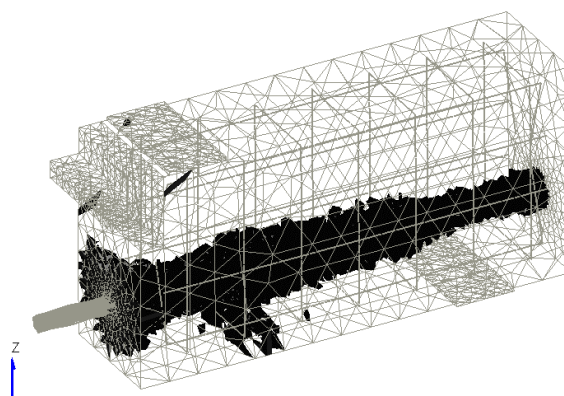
ábra: A betonban kialakult repedések a kapcsolat tönkremenetele után bordázott betonacél esetén
